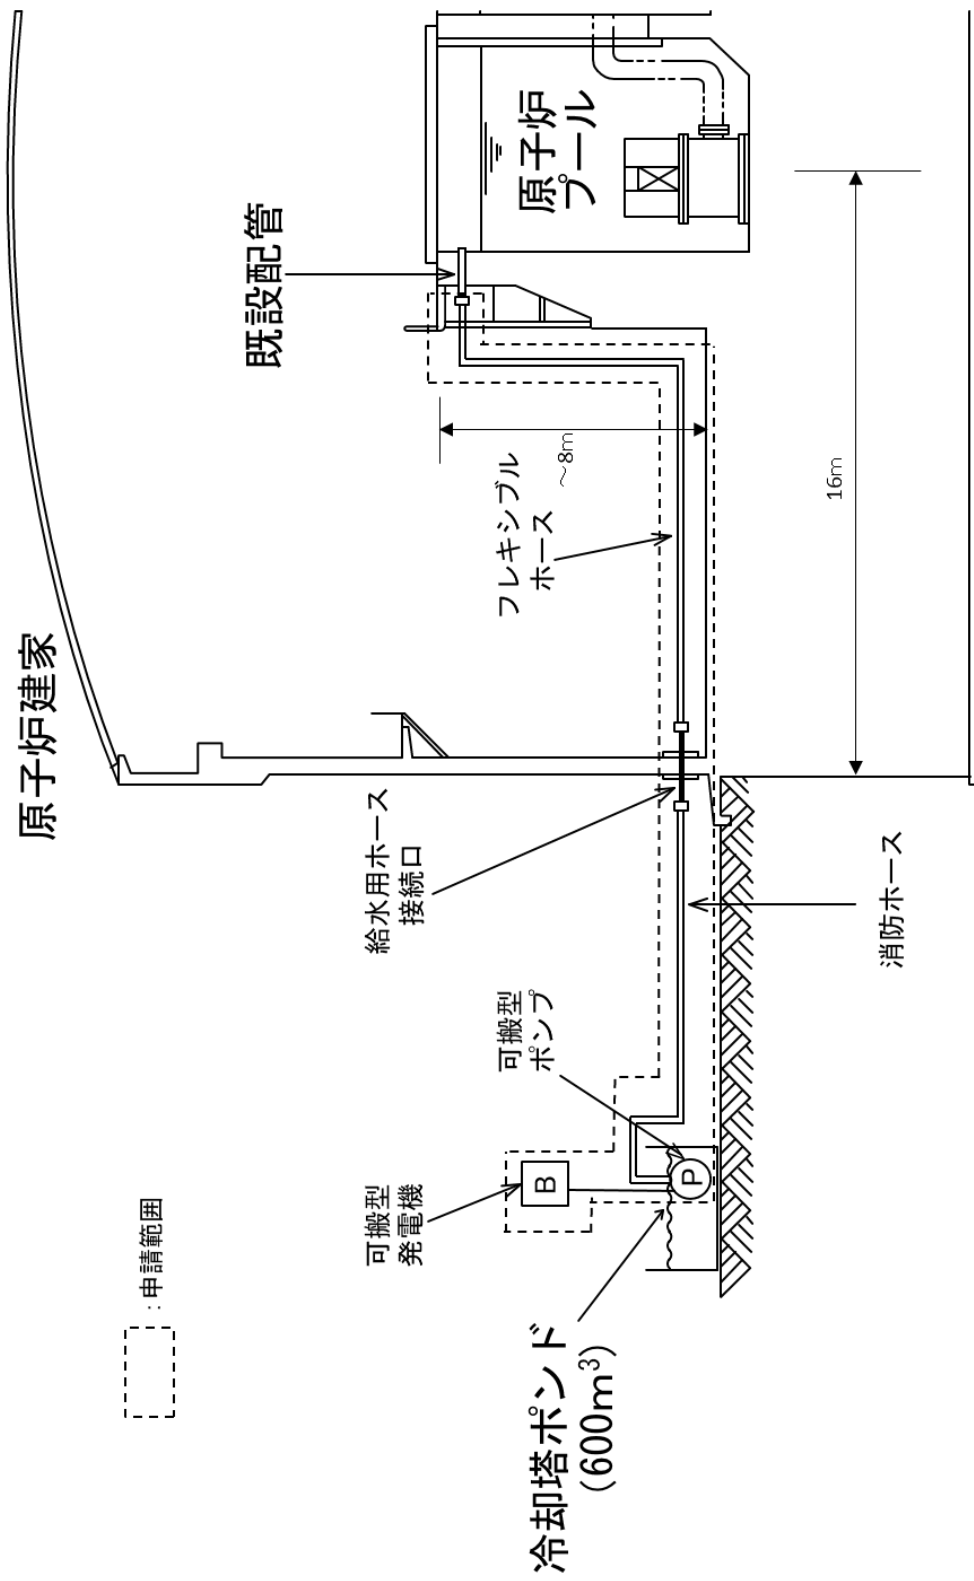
原子炉建家外の冠水維持機能喪失時用給水設備配置イメージ図 (断面図)
